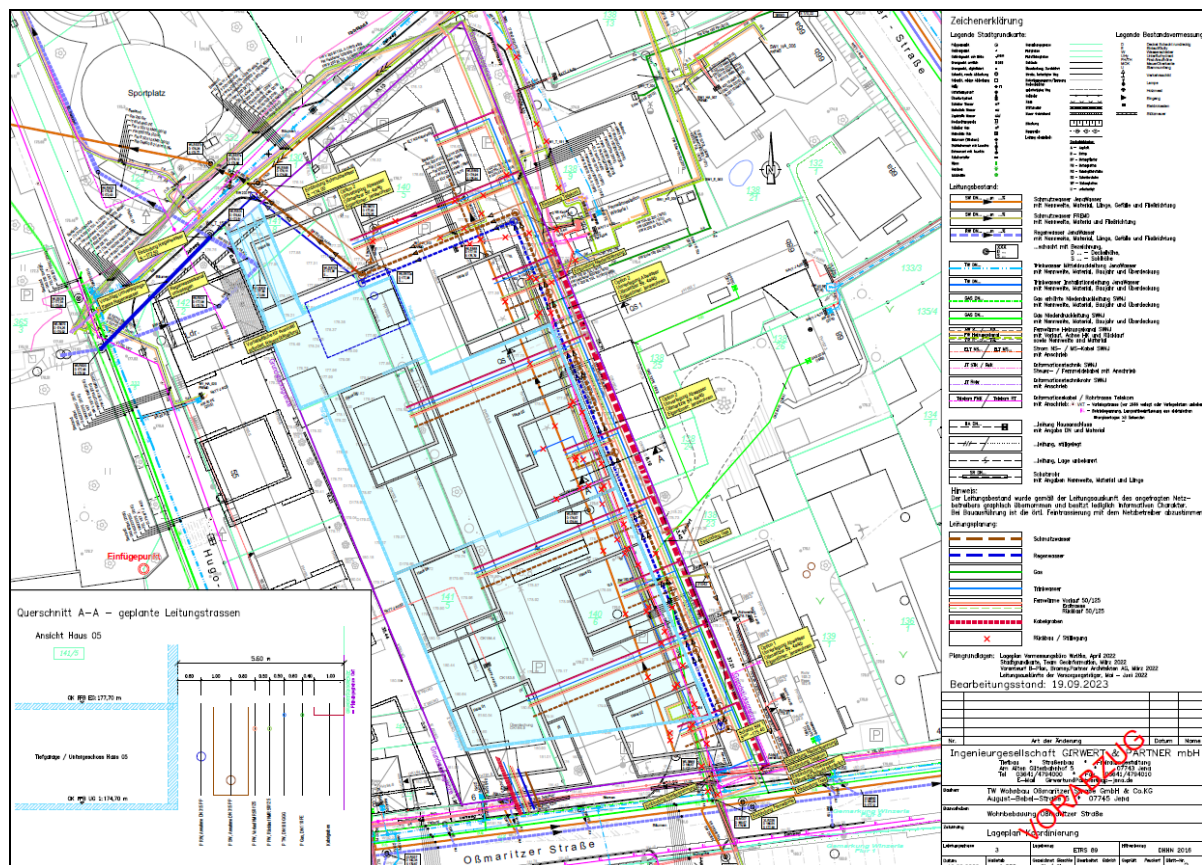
Grundzüge der koordinierten Leitungsführung an der östlichen Grundstücksgrenze (Quelle: IG Girwert & Partner mbH, Koordinierter Leitungsplan, Vorentwurf 19.09.2023)
